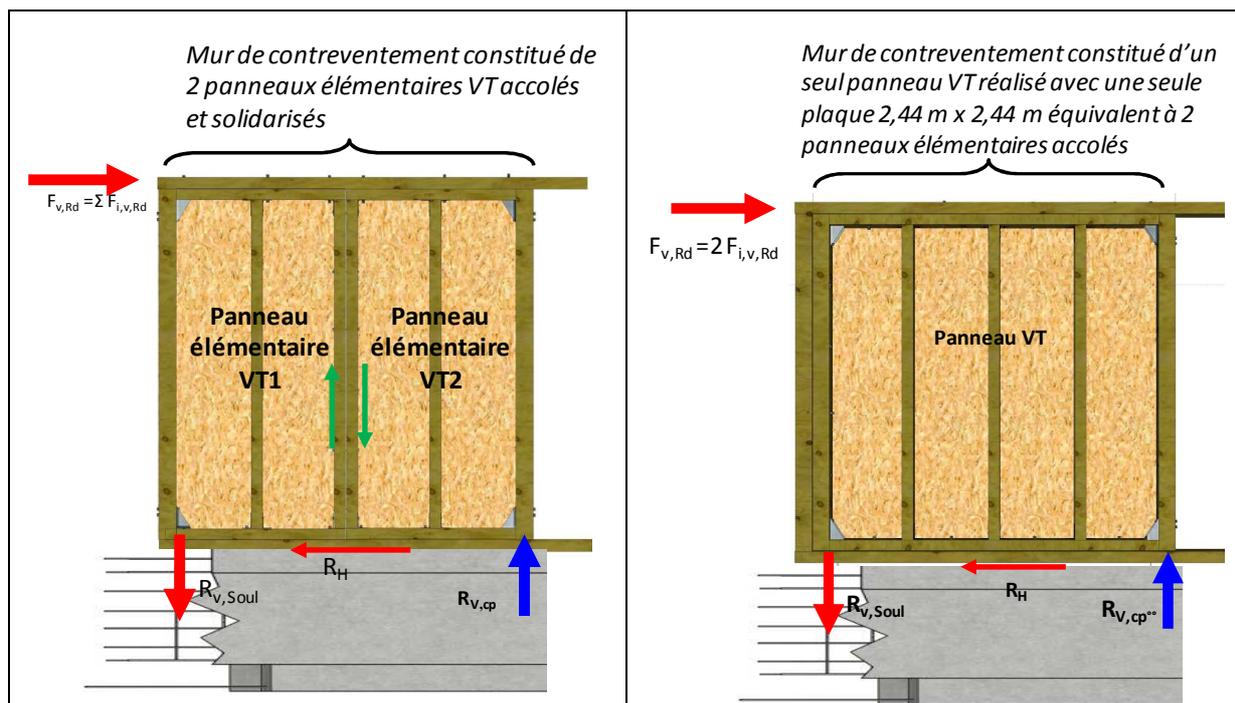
Schémas de principe d'ancrage d'un mur de contreventement constitué de 2 panneaux élémentaires VT assemblés mécaniquement
